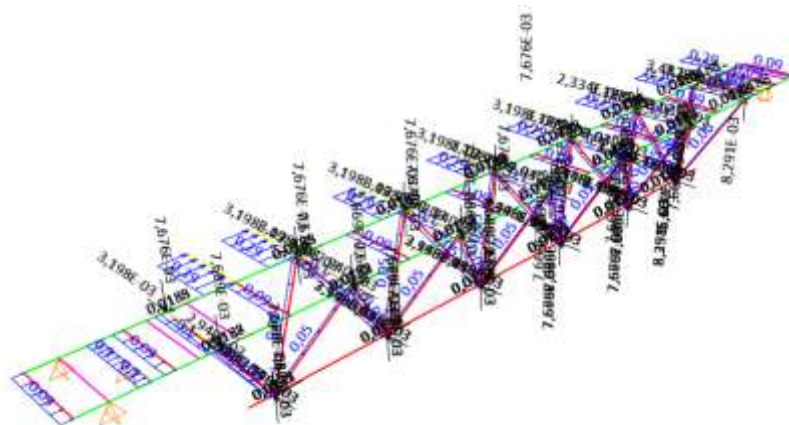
Beban Angin (WX) yang diterima Struktur *Catwalk 12
